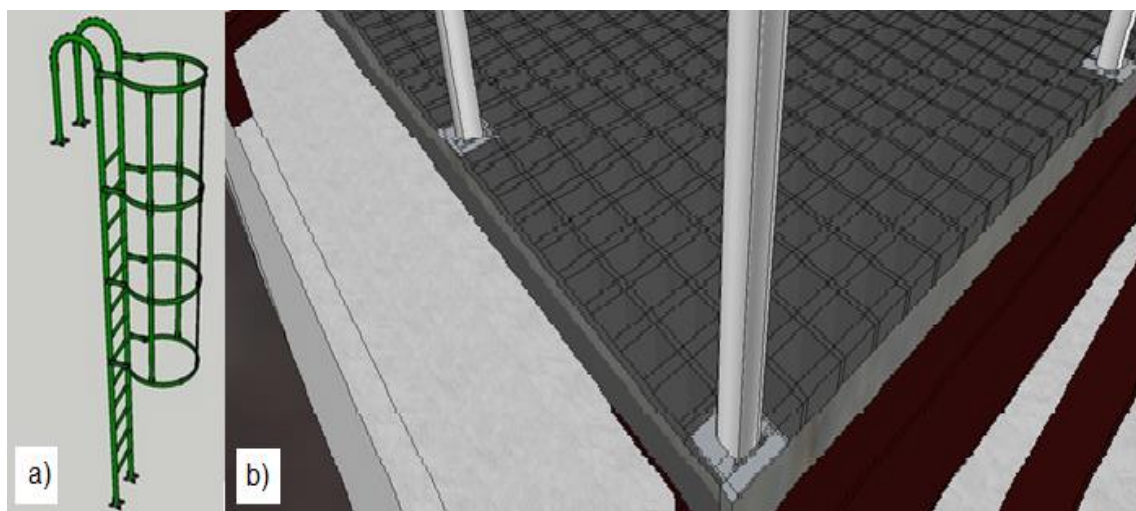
a) Diseño de escalera propuesta para acceso de emergencia a la planta piloto (diseño de 3dwarehouse en SketchUp). b) Rejilla sobre estructura de entrepiso con pasamanos representados.
